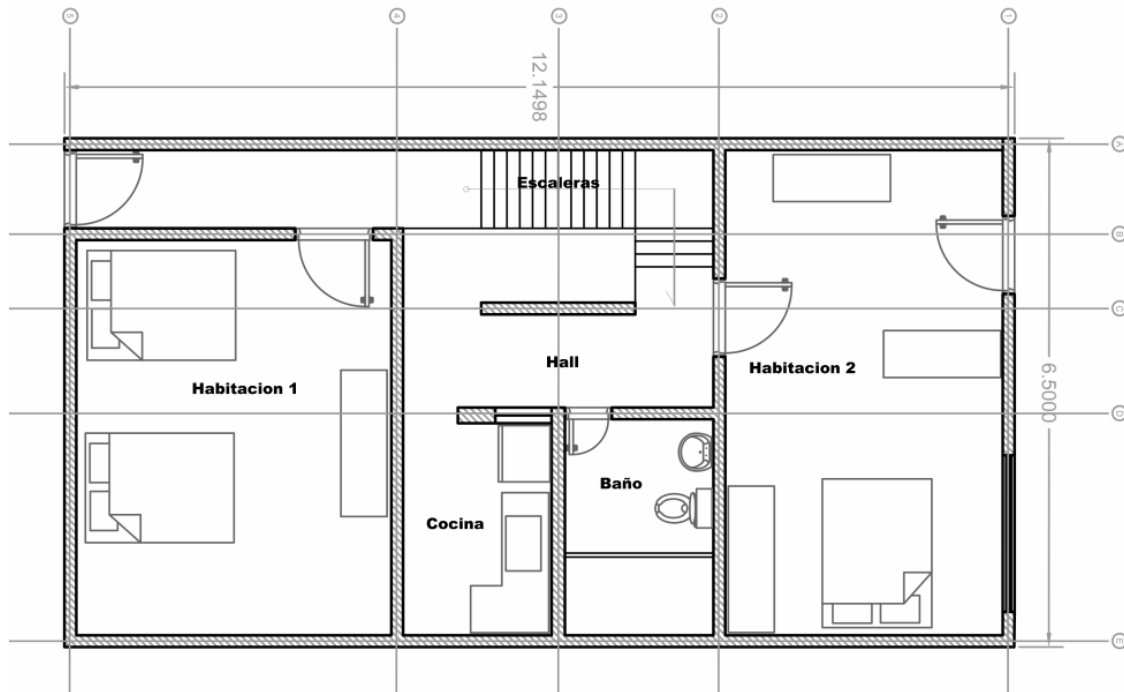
Proyecto vivienda popular, planta arquitectónica. Levantamiento 2015.
